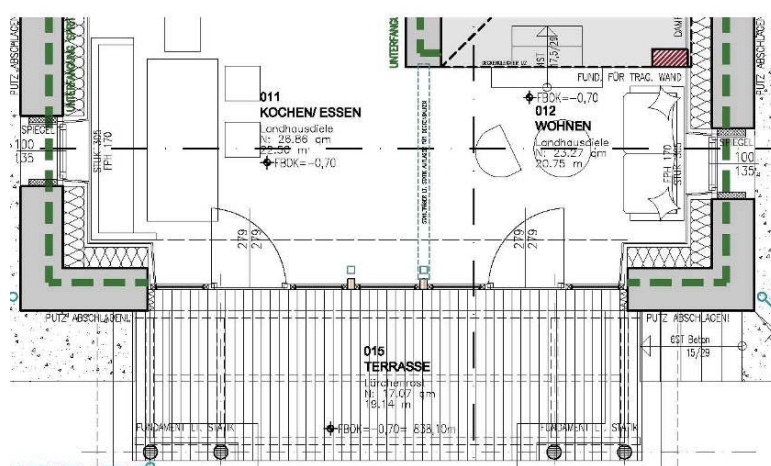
Grundriss südlicher Teil des EG mit Innendämmung
